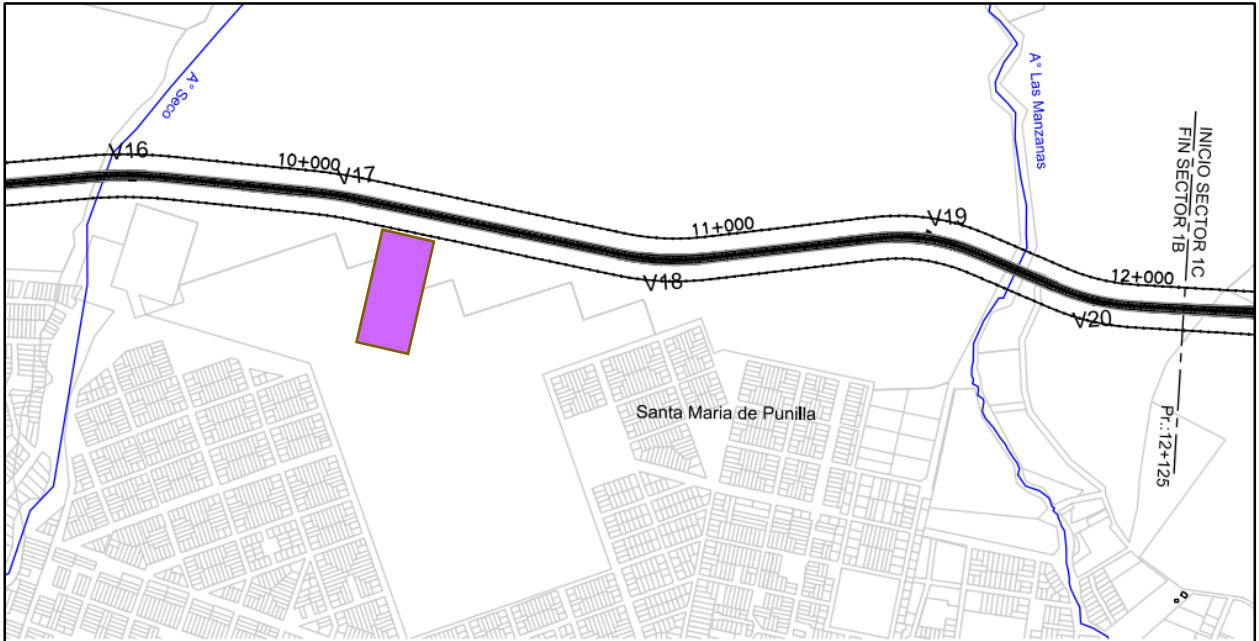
Ubicación del obrador (ver Plano N° CL-GRAL (AURN38)001-R0: Planimetría General).
